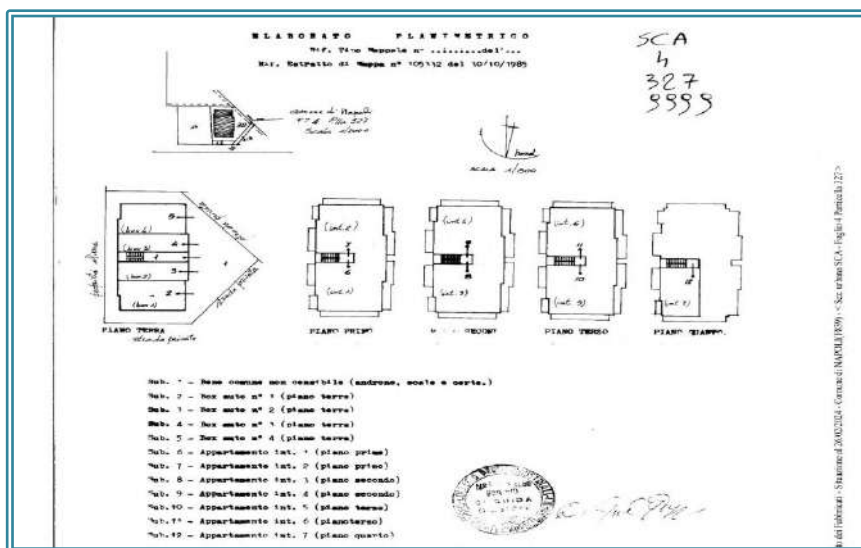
Elaborato planimetrico (TUTTI I LOTTI)
